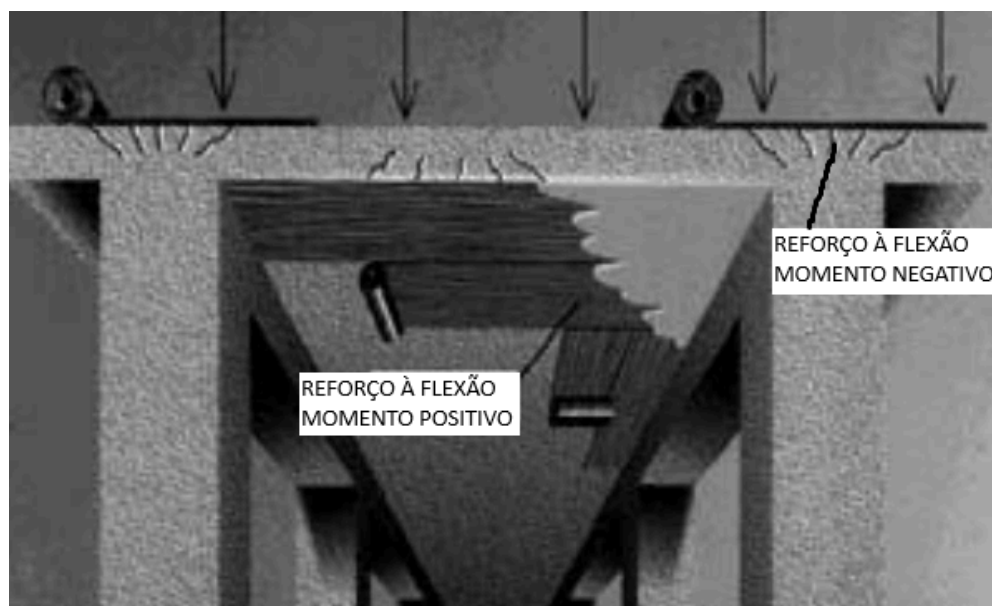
Esquema de reforço de lajes à flexão com combate à fissuração.
